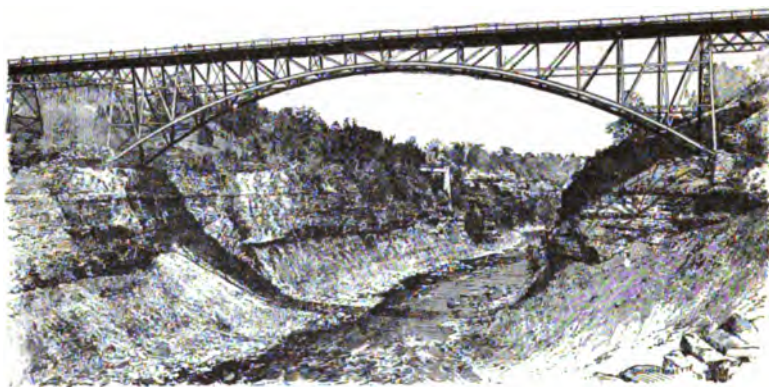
Pont de Rochester (d'après la « Rail-Road Gazette »).
